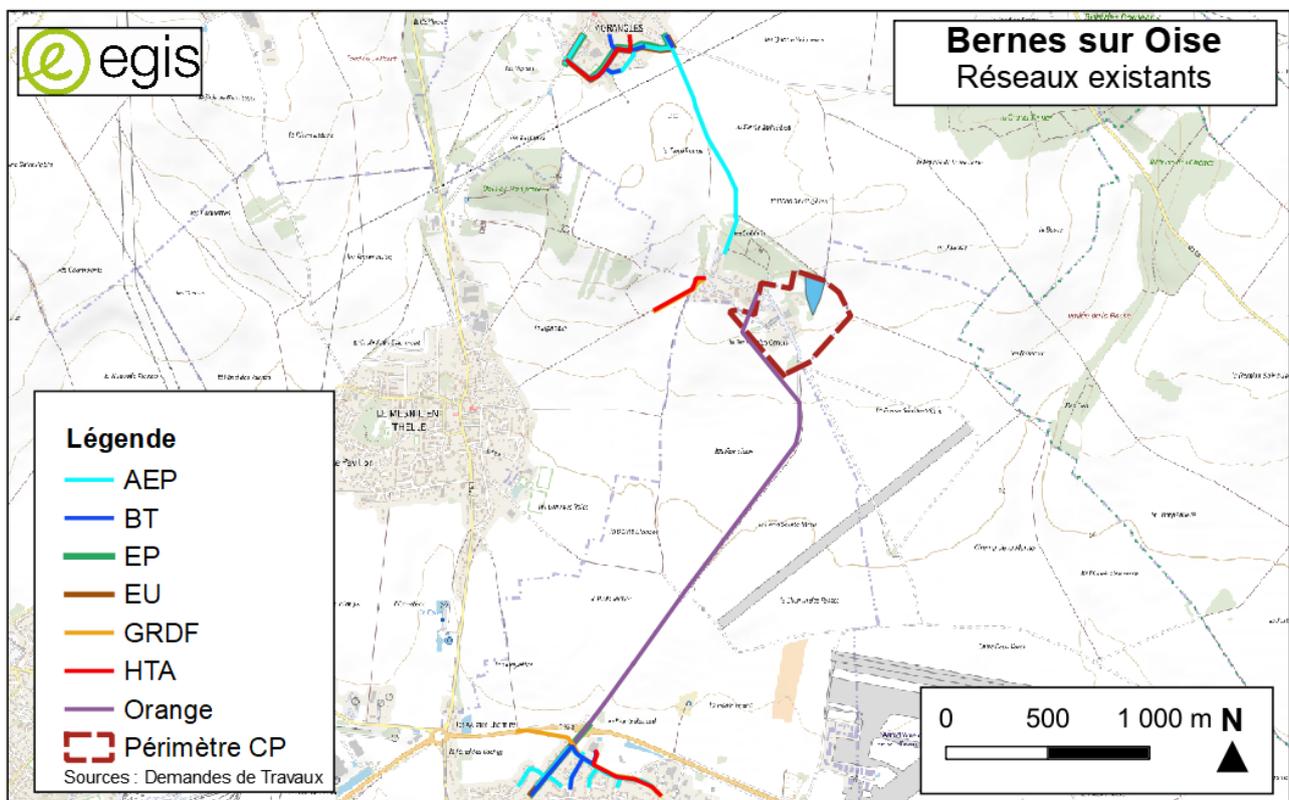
PLAN DES RESEAUX EXISTANTS GENERAL
